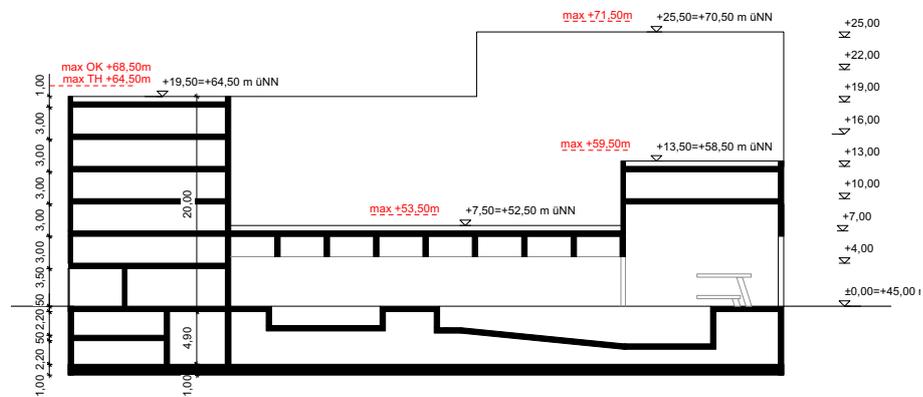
Schnitt und Grundriss Variante 2, o.M
